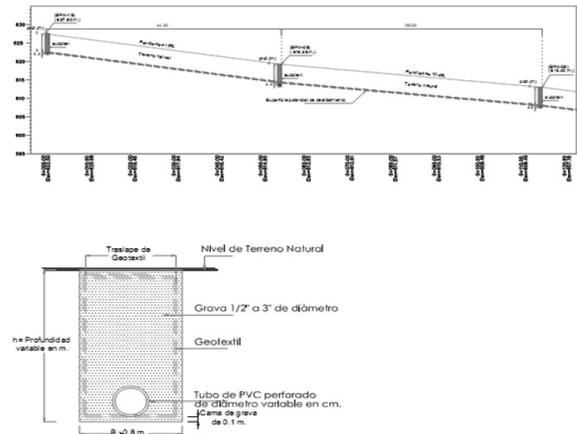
Estabilización de taludes con obras de drenaje y subdrenaje. (Ordóñez J. 2014).
